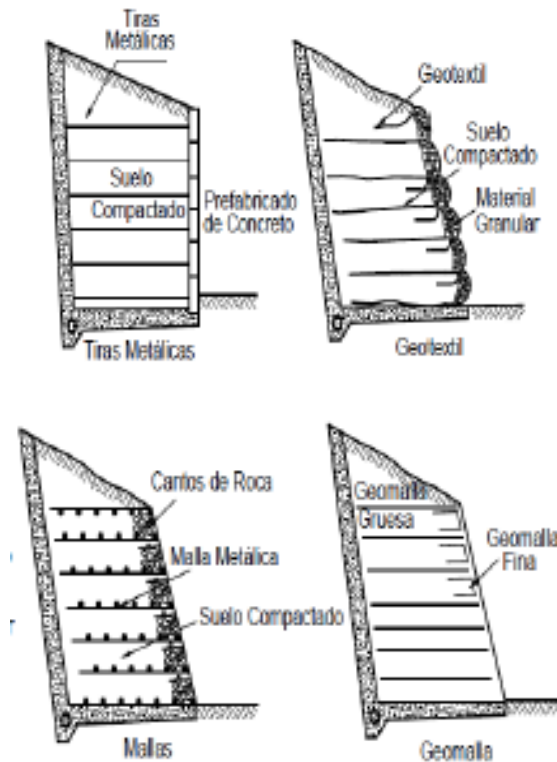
Tipos de refuerzo para muros de suelo reforzado
